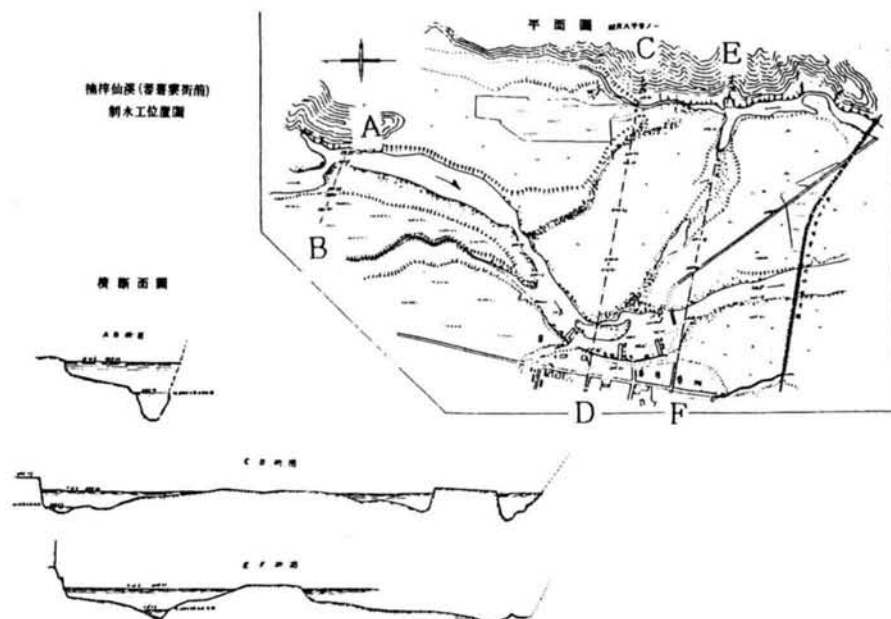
台湾楠梓仙溪制水工、横断面図及び平面図<sup>9)</sup>
